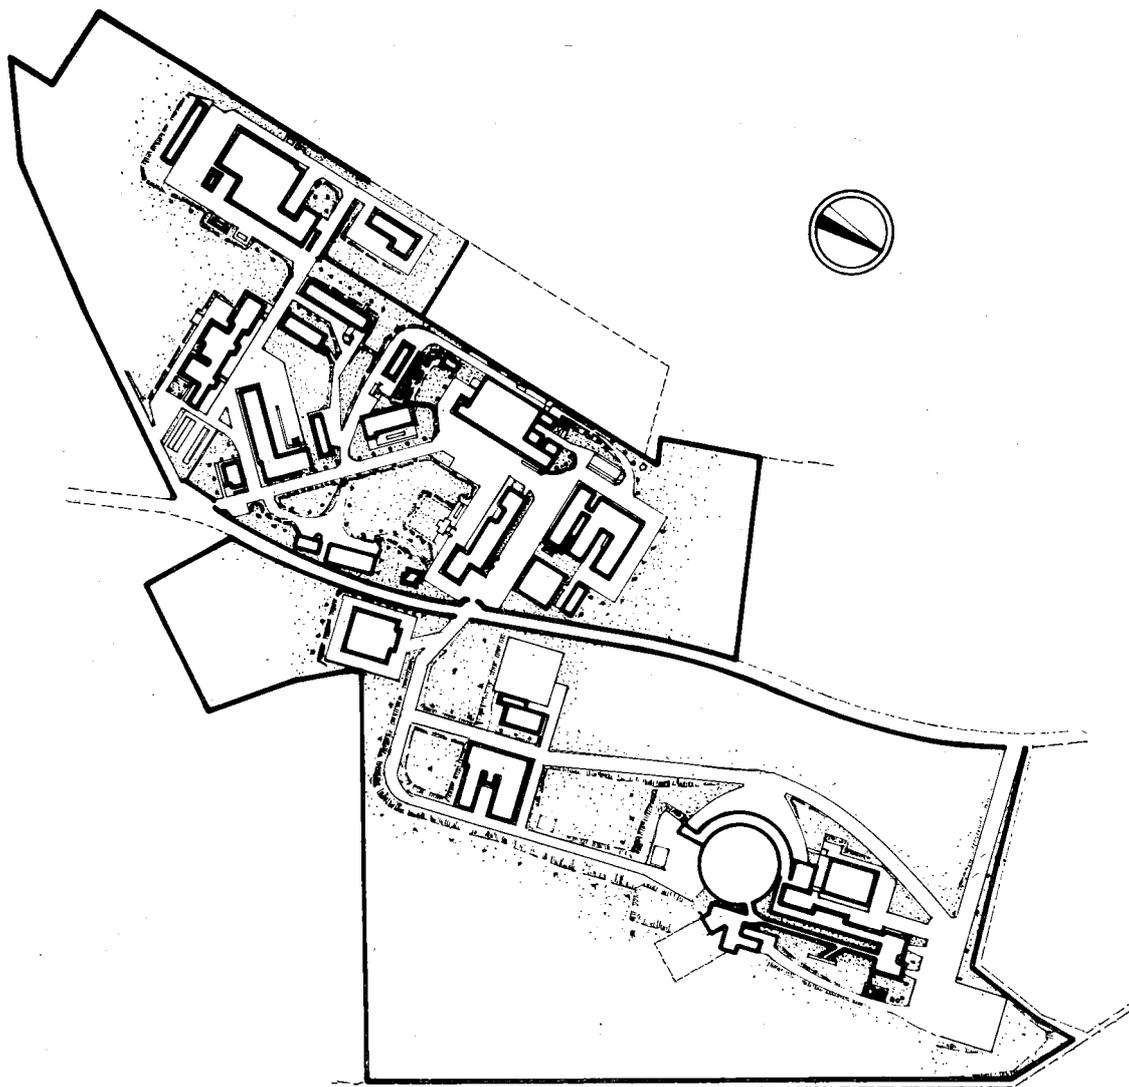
Planimetria generale del Centro di Frascati; nella nuova area è indicata la sistemazione urbanistica dei primi edifici.
